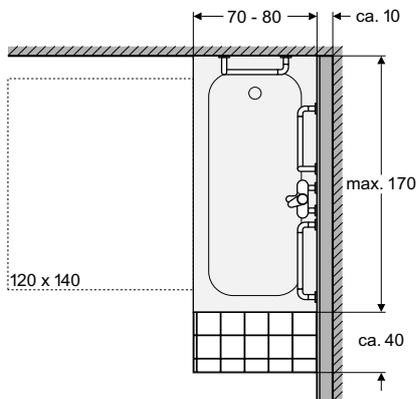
Badewanne, Grundriss mit Bewegungsfläche für Rollstuhlfahrer
